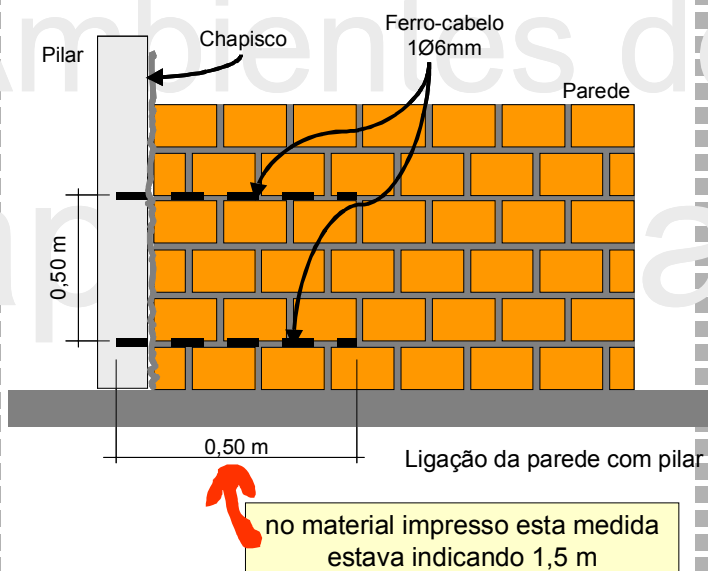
Croqui de ligação padrão de pilar com alvenaria
